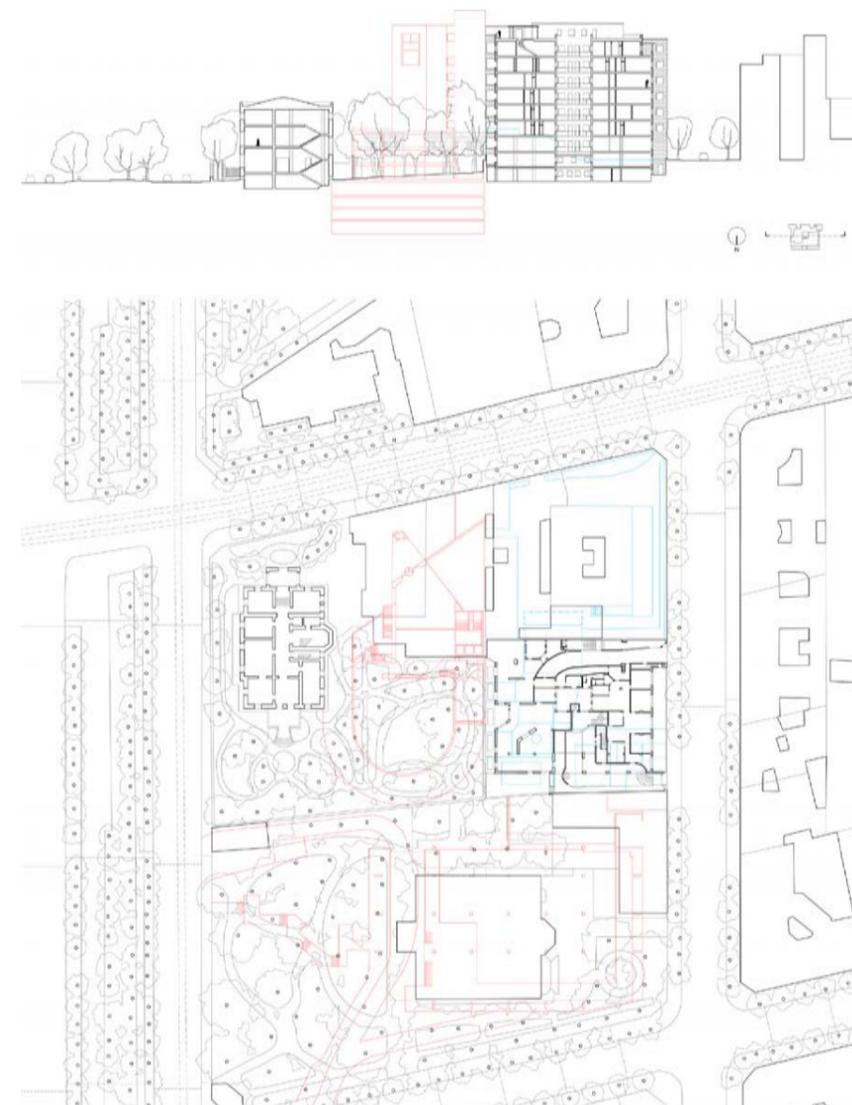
Planta baja y sección general de la manzana. En rojo, arquitecturas posteriores a Fortuny 14; en azul, las anteriores. Elaboración propia.
